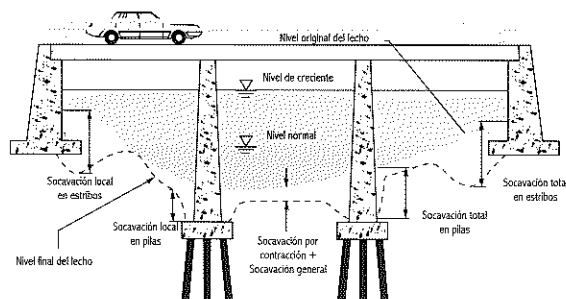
Tipos de socavación que pueden ocurrir en un puente
